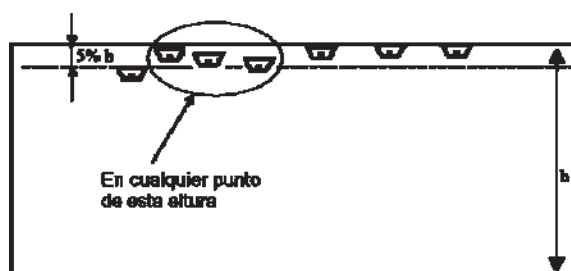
Emplazamiento y separación bajo falsos techos.
